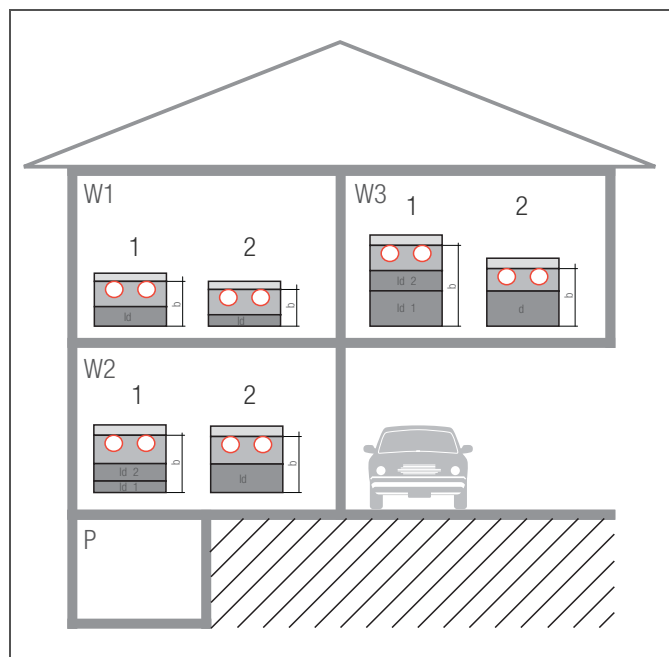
Przykładowy plan ułożenia systemu suchej zabudowy TS-14
